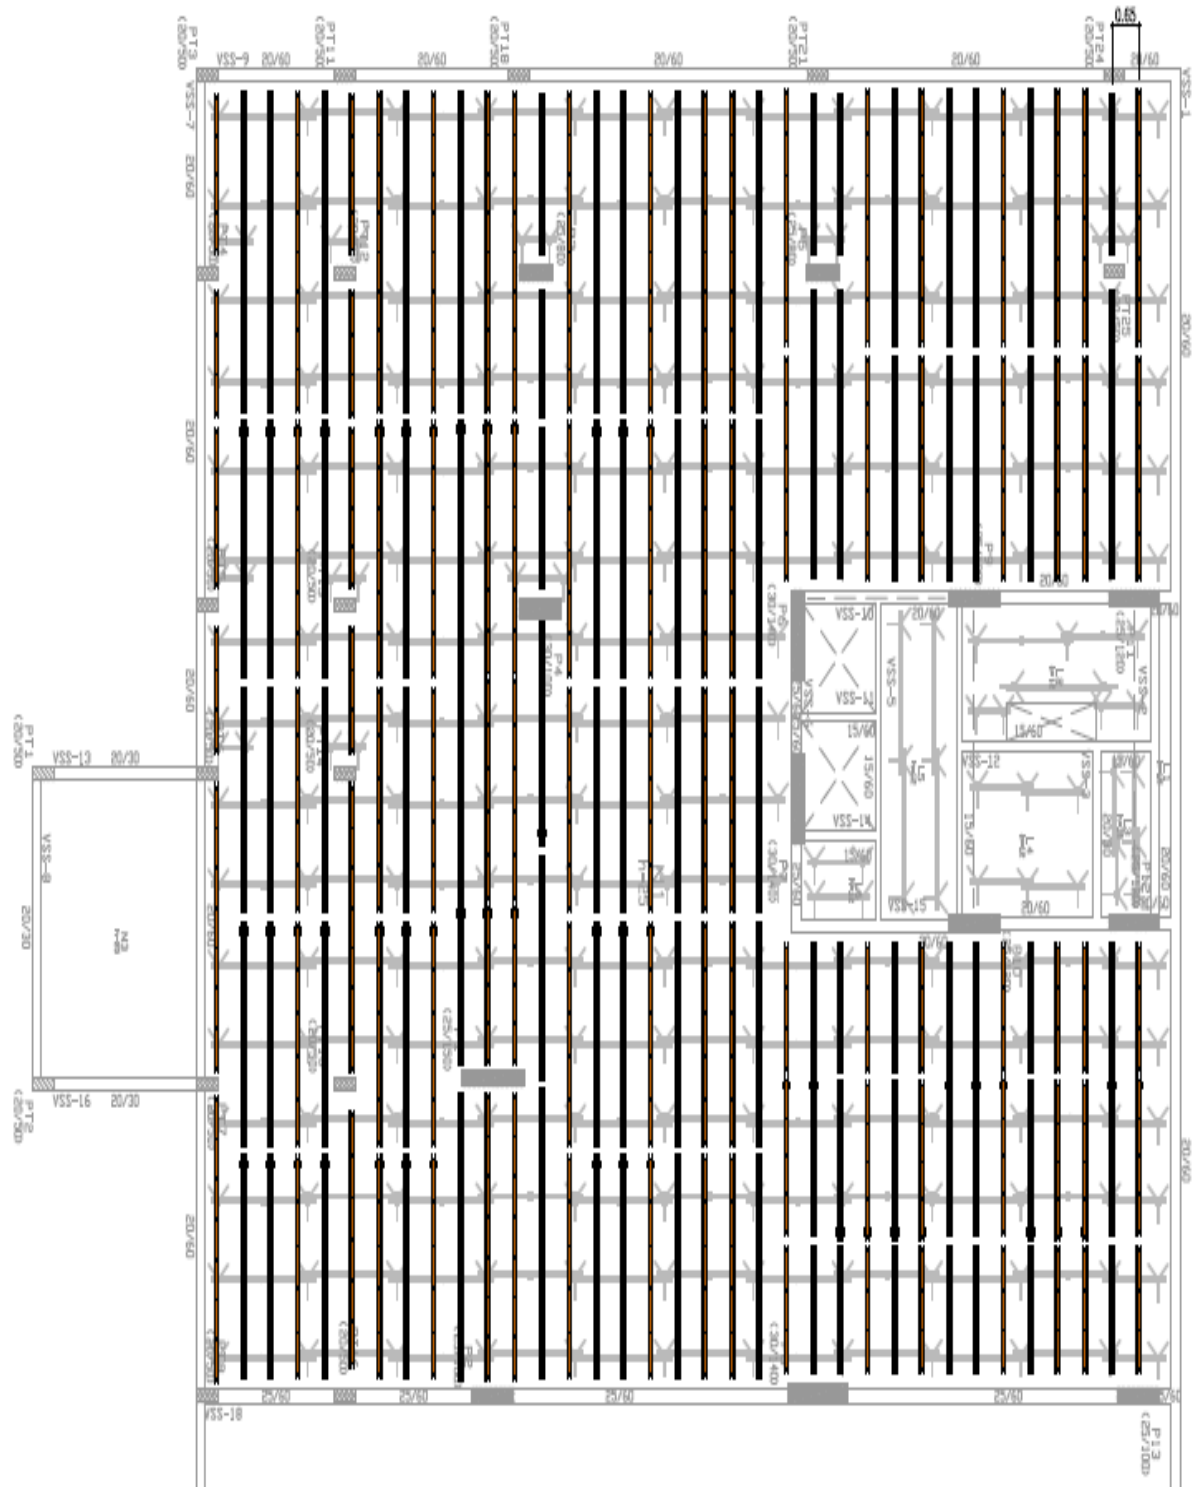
Edifício 2: Planta do Cimbramento principal da laje
